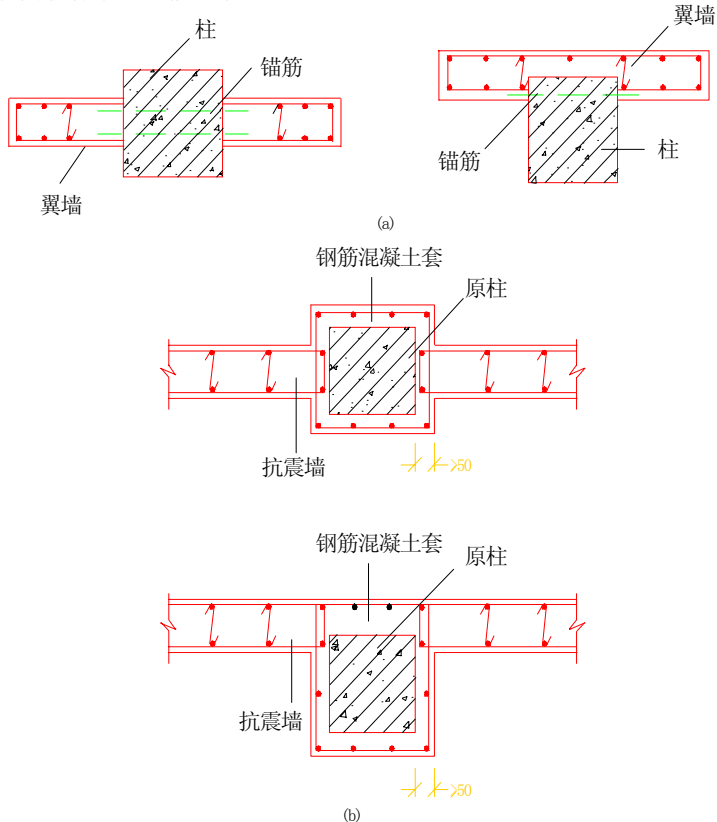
锚筋或现浇钢筋混凝土套连接
